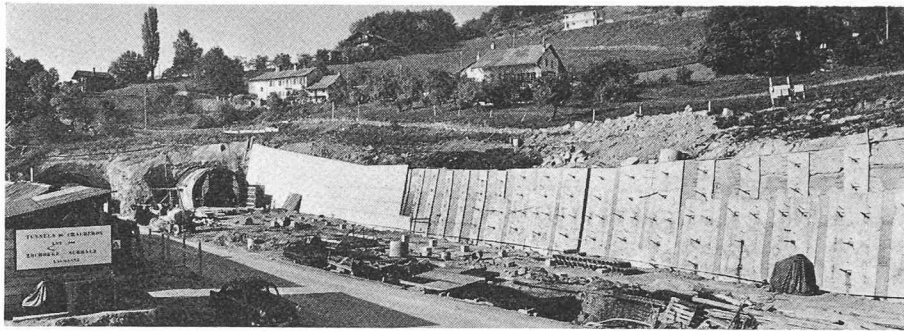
Mur de Chauderon. Vue d'ensemble, piliers et placage.
